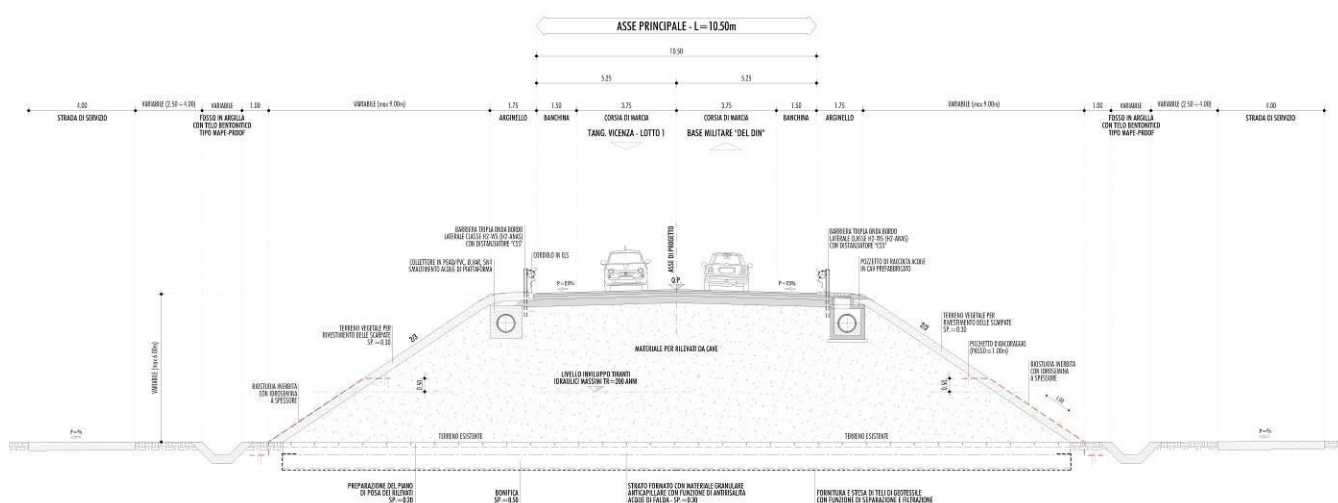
SEZIONE TIPO IN RILEVATO
